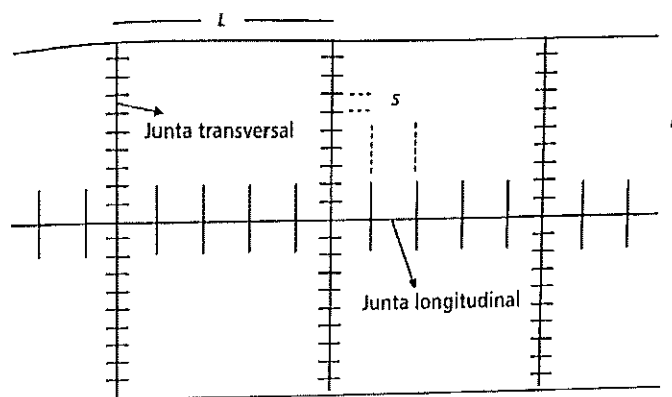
Vista en planta típica de una losa de pavimento rígido con junta con pasadores y barras de anclaje.
